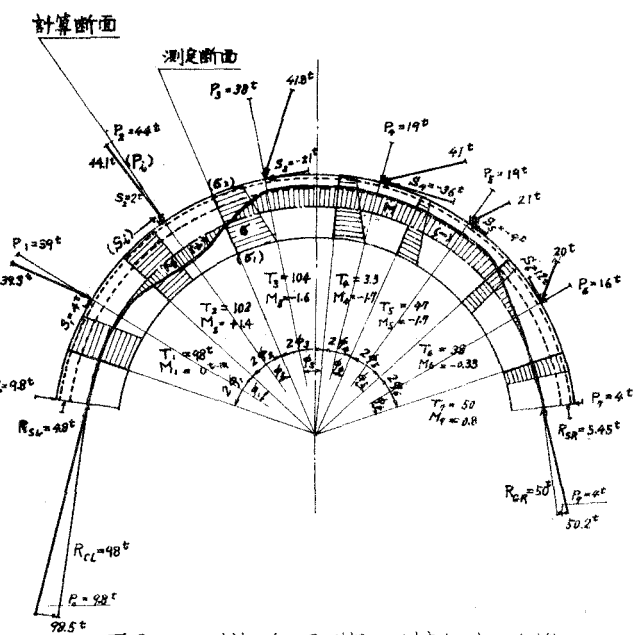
コンクリート施工後180日におけるコンクリート応力と外力の状態
